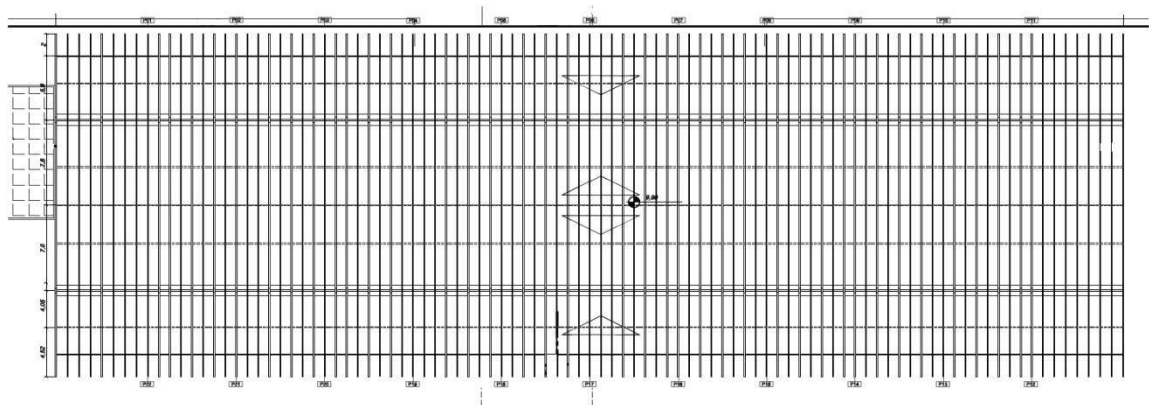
Planta de Cobertura. Fonte: ALBERNAZ, 2012.
